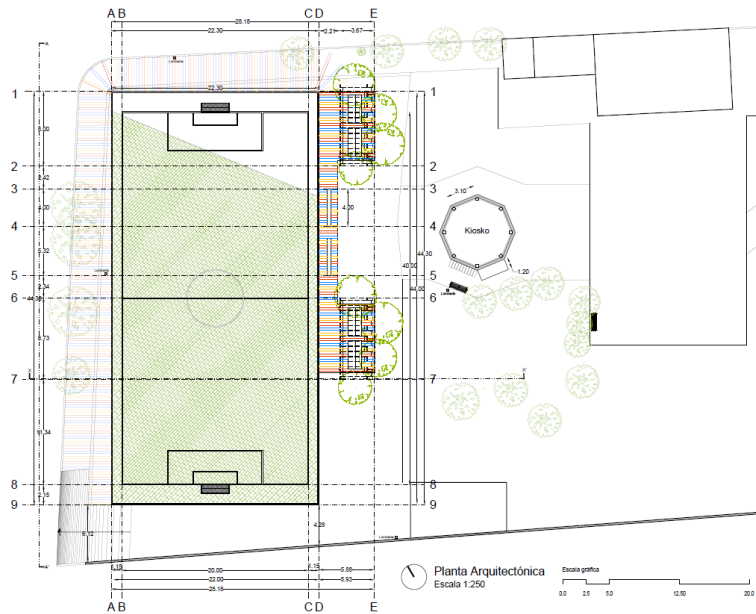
Planta arquitectónica de segunda propuesta. (Autoría 2017).
